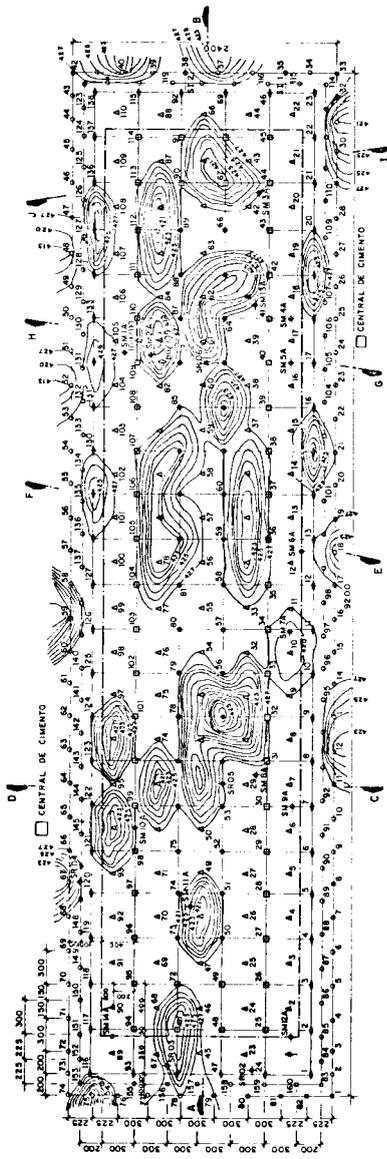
Perfil das cavernas da Estação de Bombeamento-EB-1 — Jaíba
